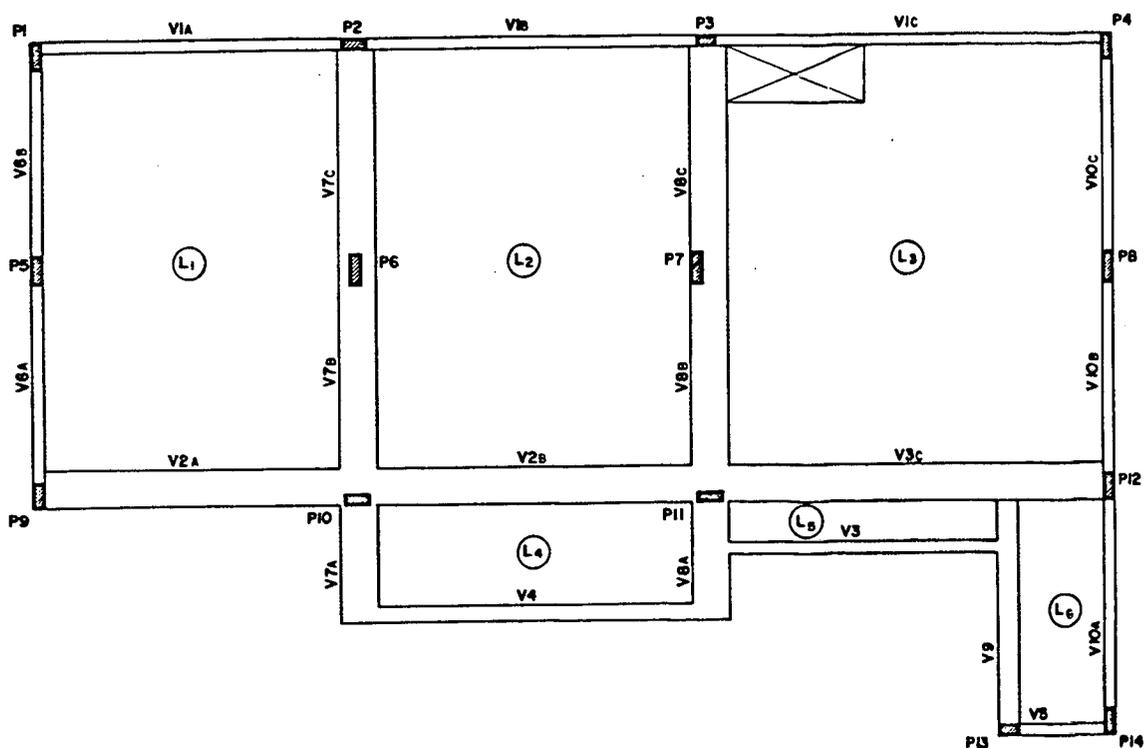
Esquema estrutural para lajes nervuradas - Projeto Grande
